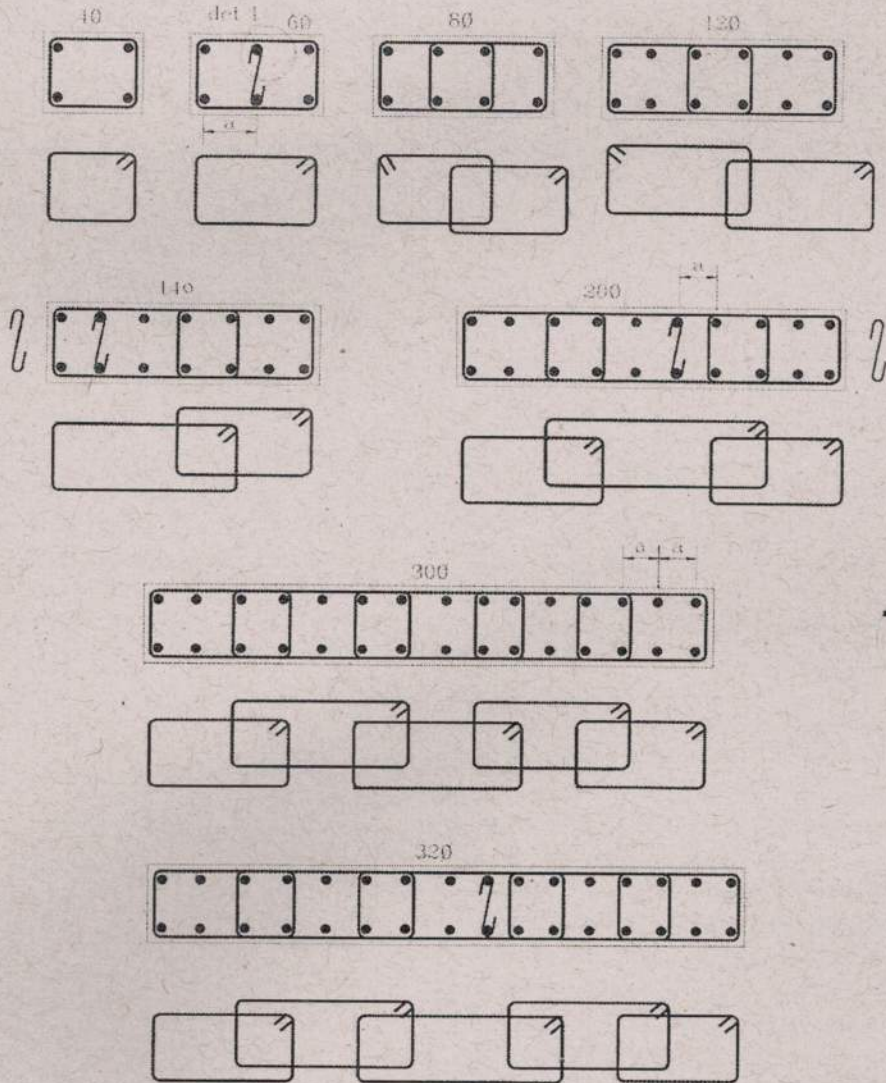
Arranjos de estribos para pilares retangulares (FIORIN (1998))
